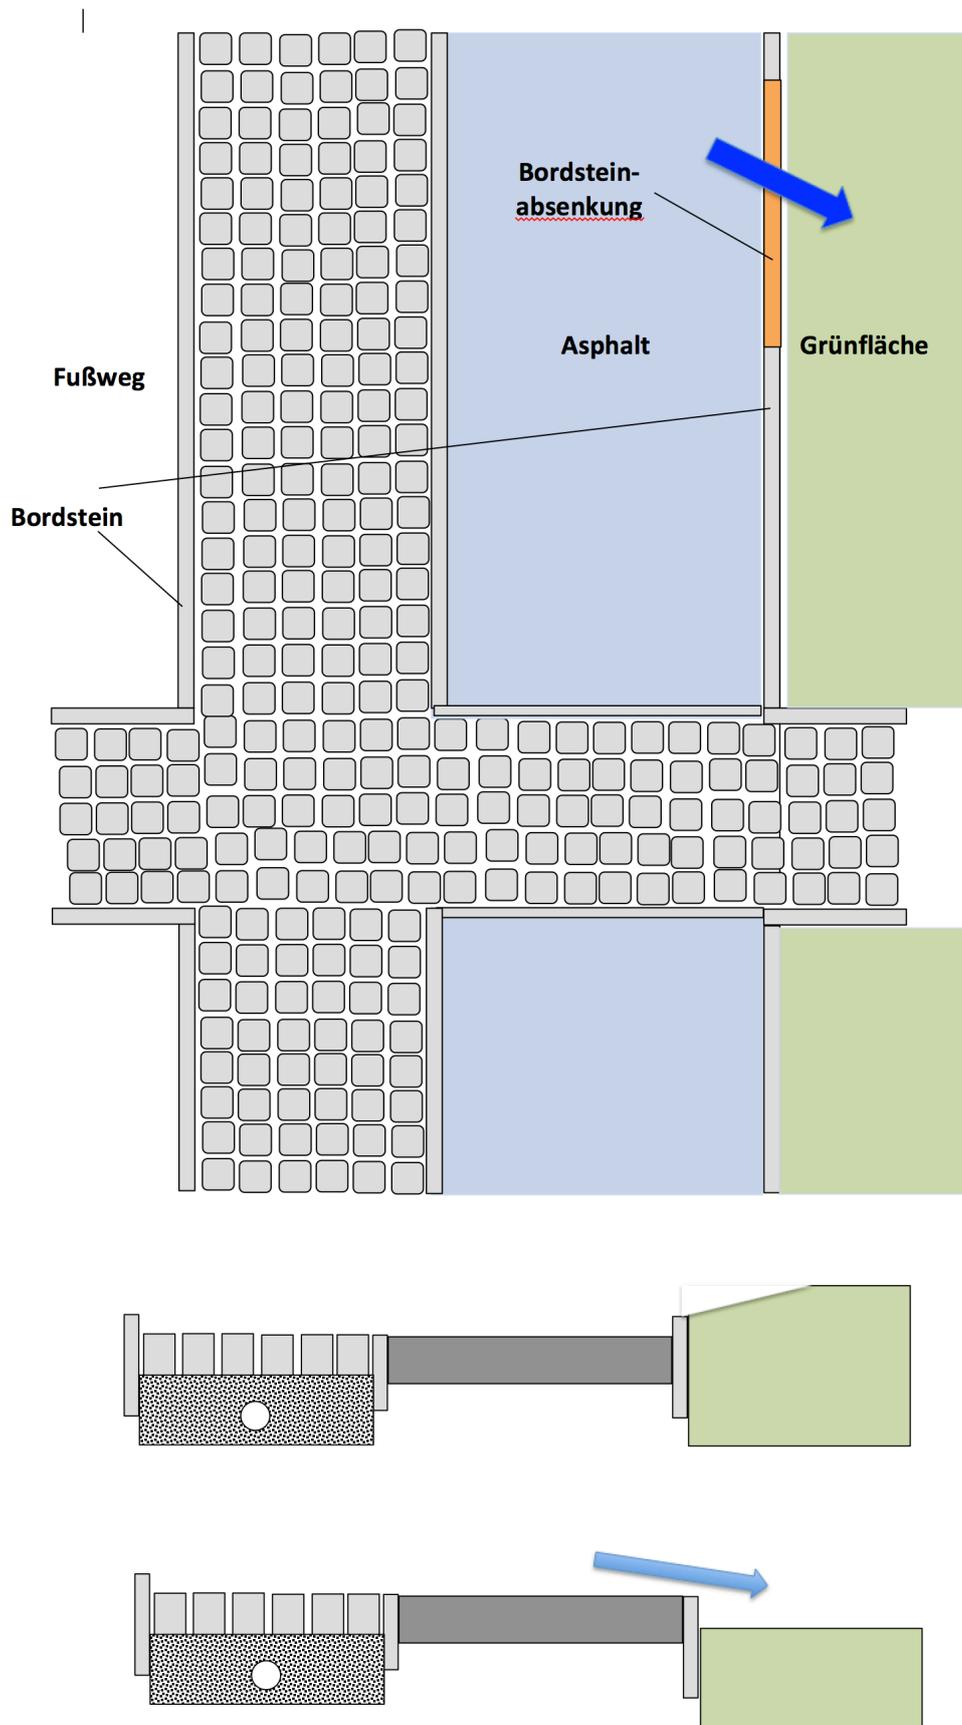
neuer Straßenaufbau für eine zweispurige Straße mit Grünfläche
